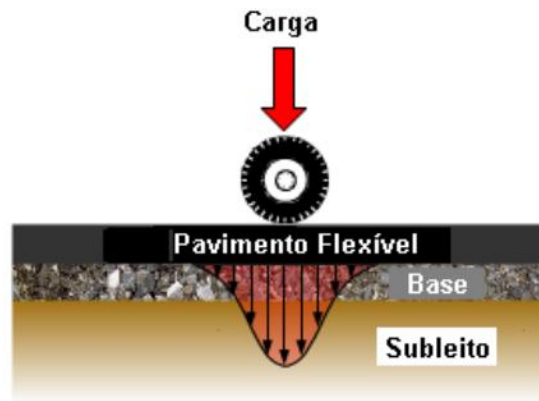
Campo de Tensões de Pavimentos Flexíveis
